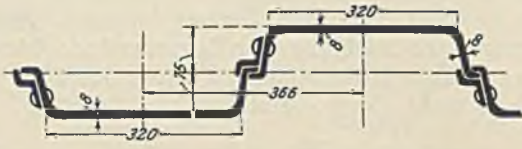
Alte Bauart Larssen. Das Schloß ist durch Nietung hergestellt.
